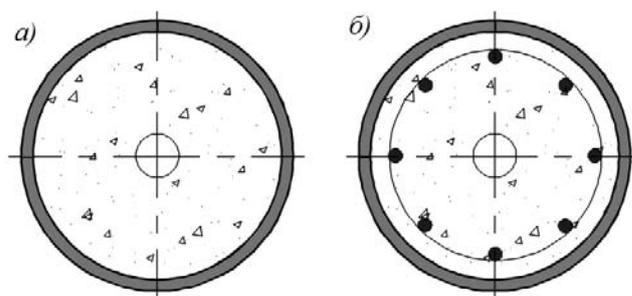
Кольцевое поперечное сечение трубобетонных колонн: а) без армирования бетонного ядра; б) с армированием бетонного ядра
